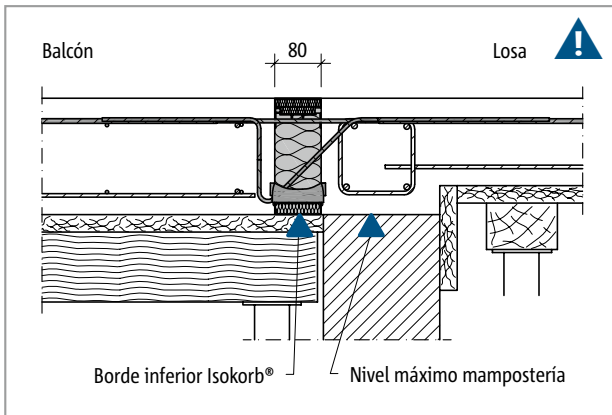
Schöck Isokorb® T tipo K: Balcón de hormigón in situ con losa desplazada en altura sobre muro de mampostería
